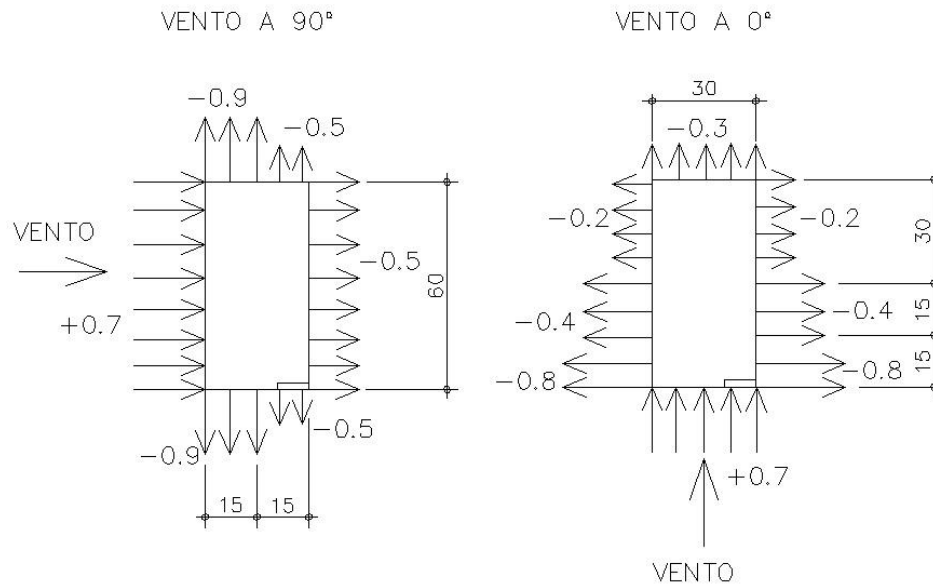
Coeficientes de pressão externa em paredes de edificações de planta baixa retangular
